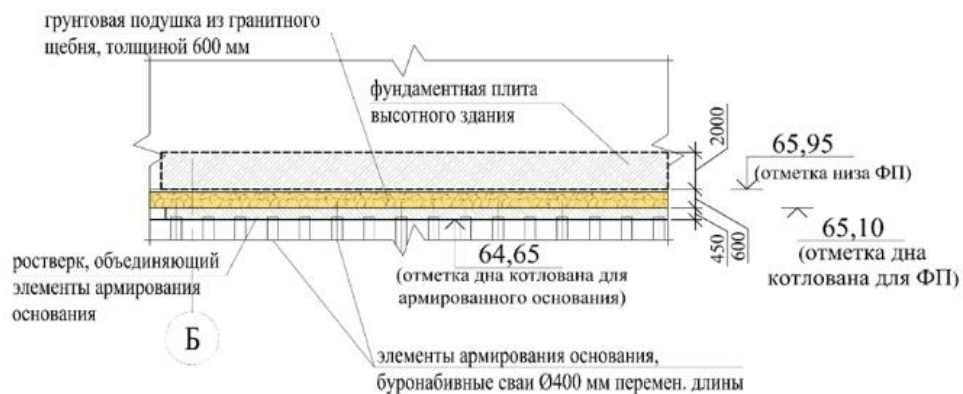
Техническое решение плитного фундамента на армированном основании для высотного здания
